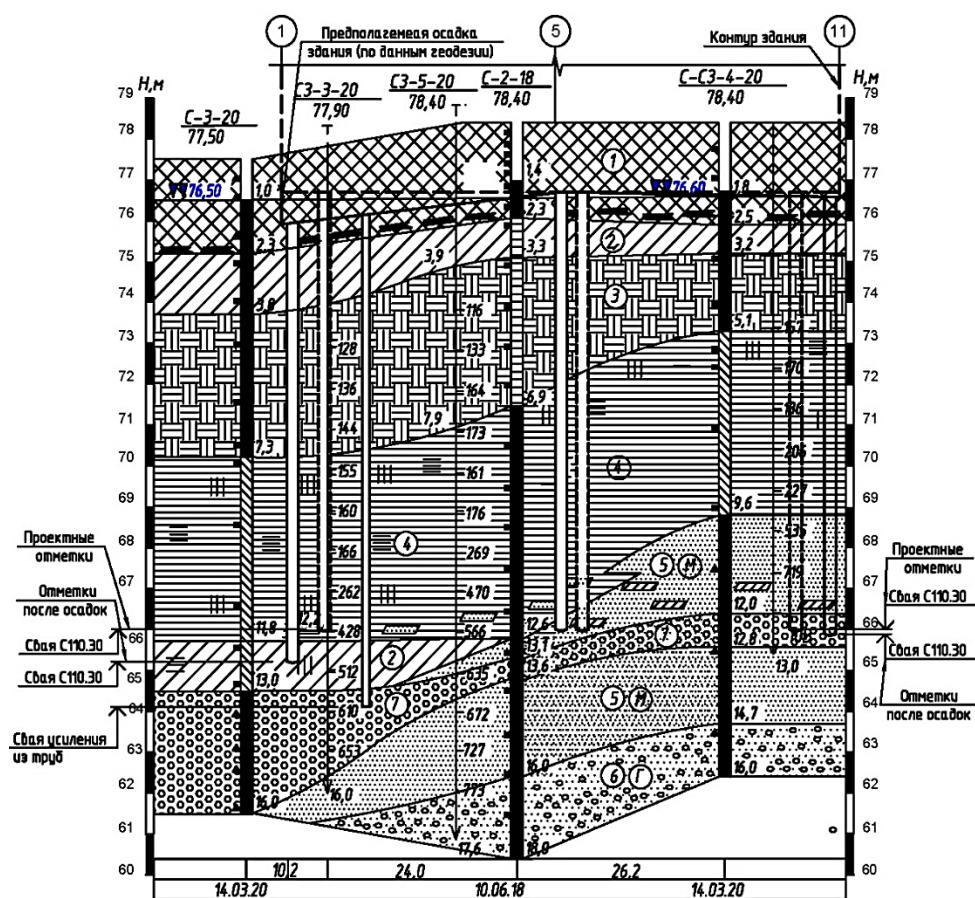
Инженерно-геологический разрез площадки здания с посадкой свайного фундамента
